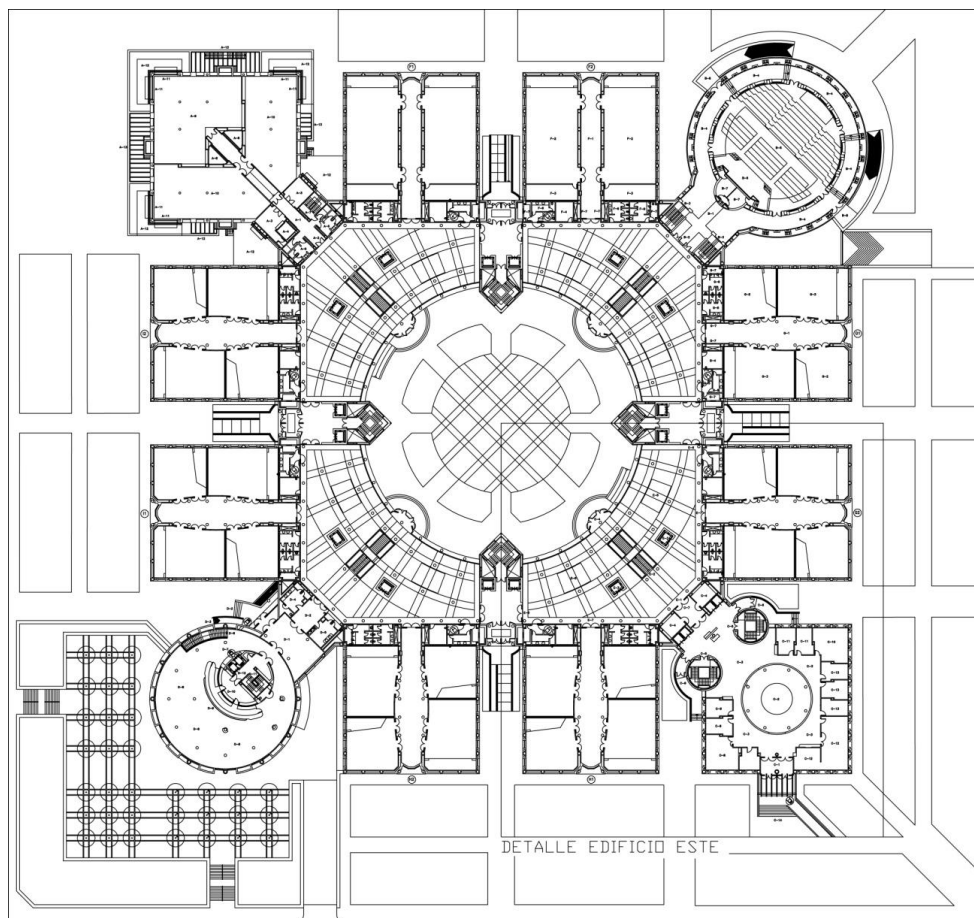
Planta baja del edificio Politécnico de la Universidad de Alcalá
